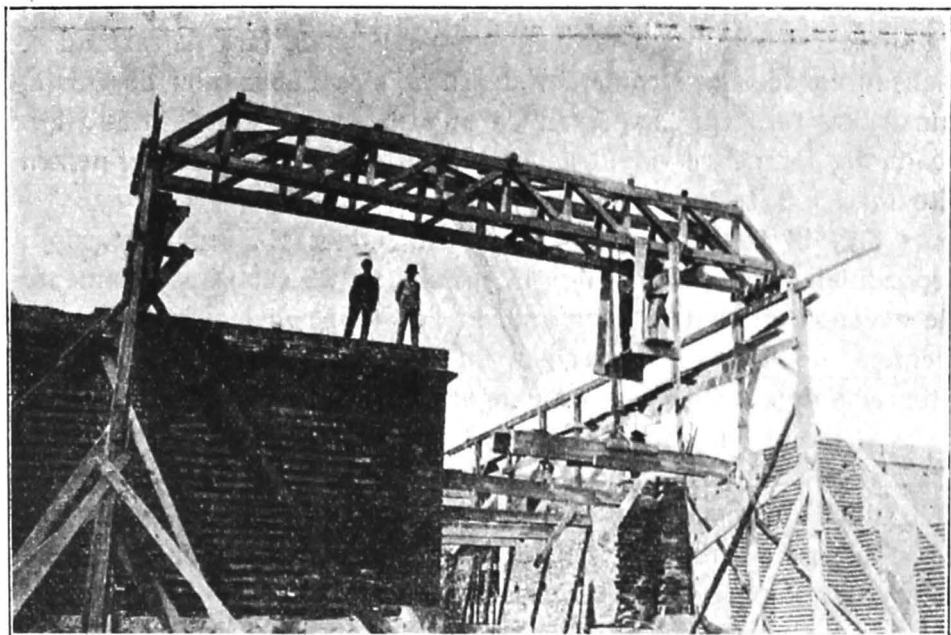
Montarea elementelor planșeului de beton armat deasupra depozitului de gheață la abatorul de frontieră de la Turnu-Severin.
